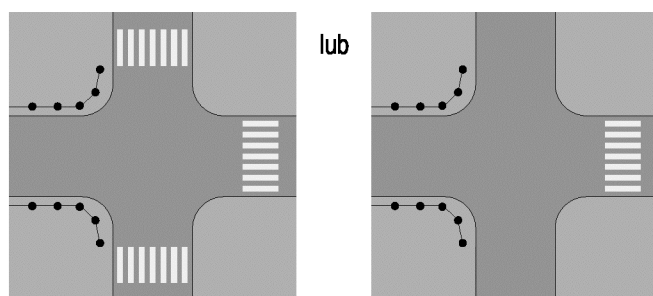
Sposób wyznaczenia przejścia dla pieszych przez powierzchnię wyłączoną z ruchu
